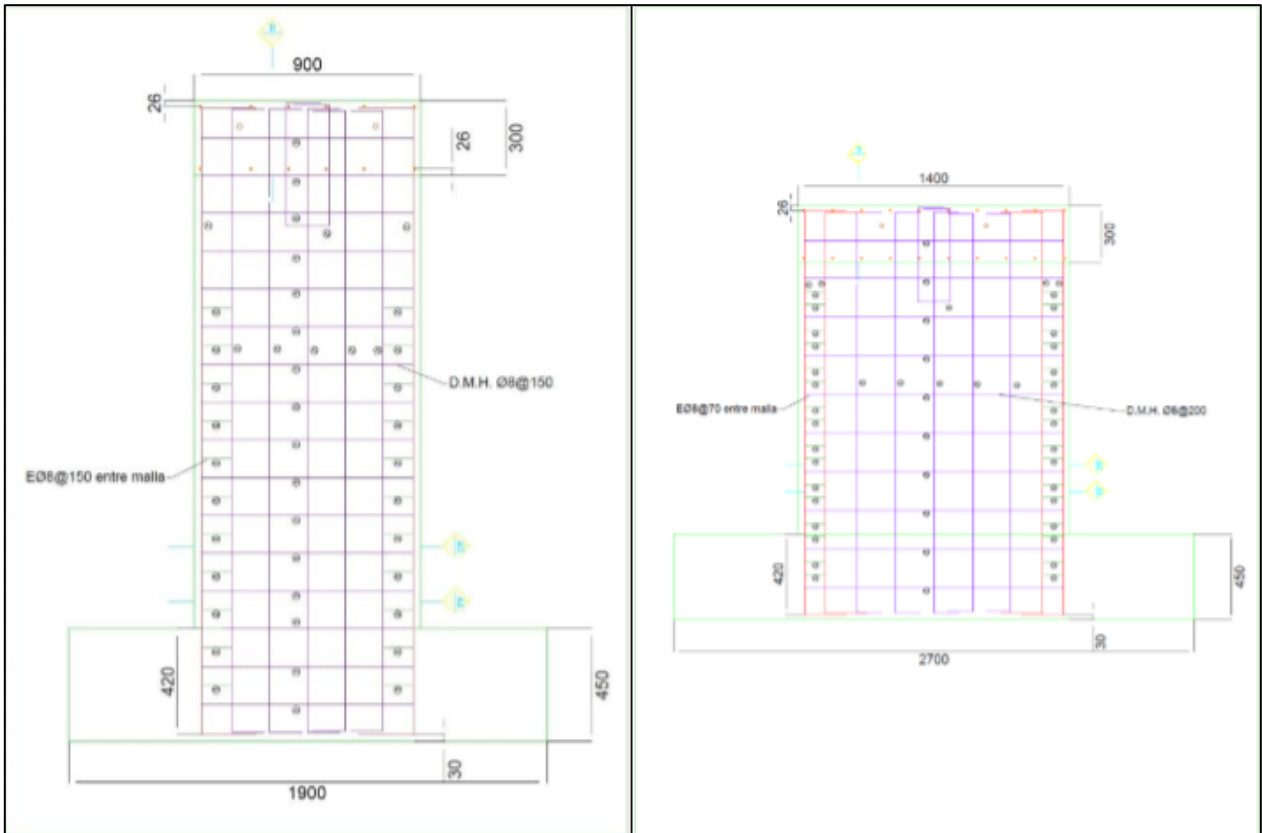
Esquema armadura de muros: izquierda Muro 1; derecha Muro 2. (ACMA, 2018)
